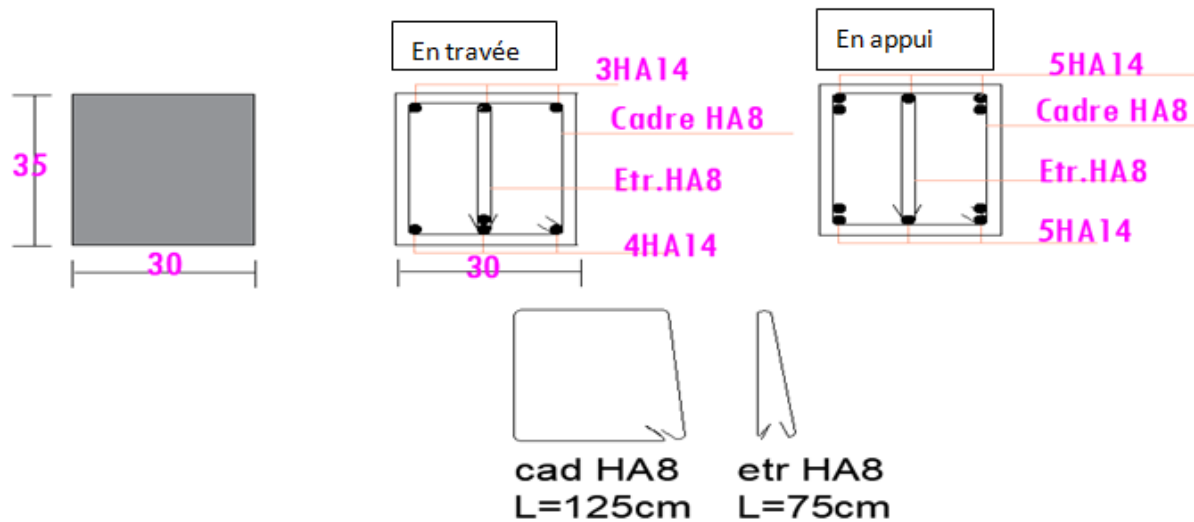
schéma ferrailage de poutre secondaire type 02
